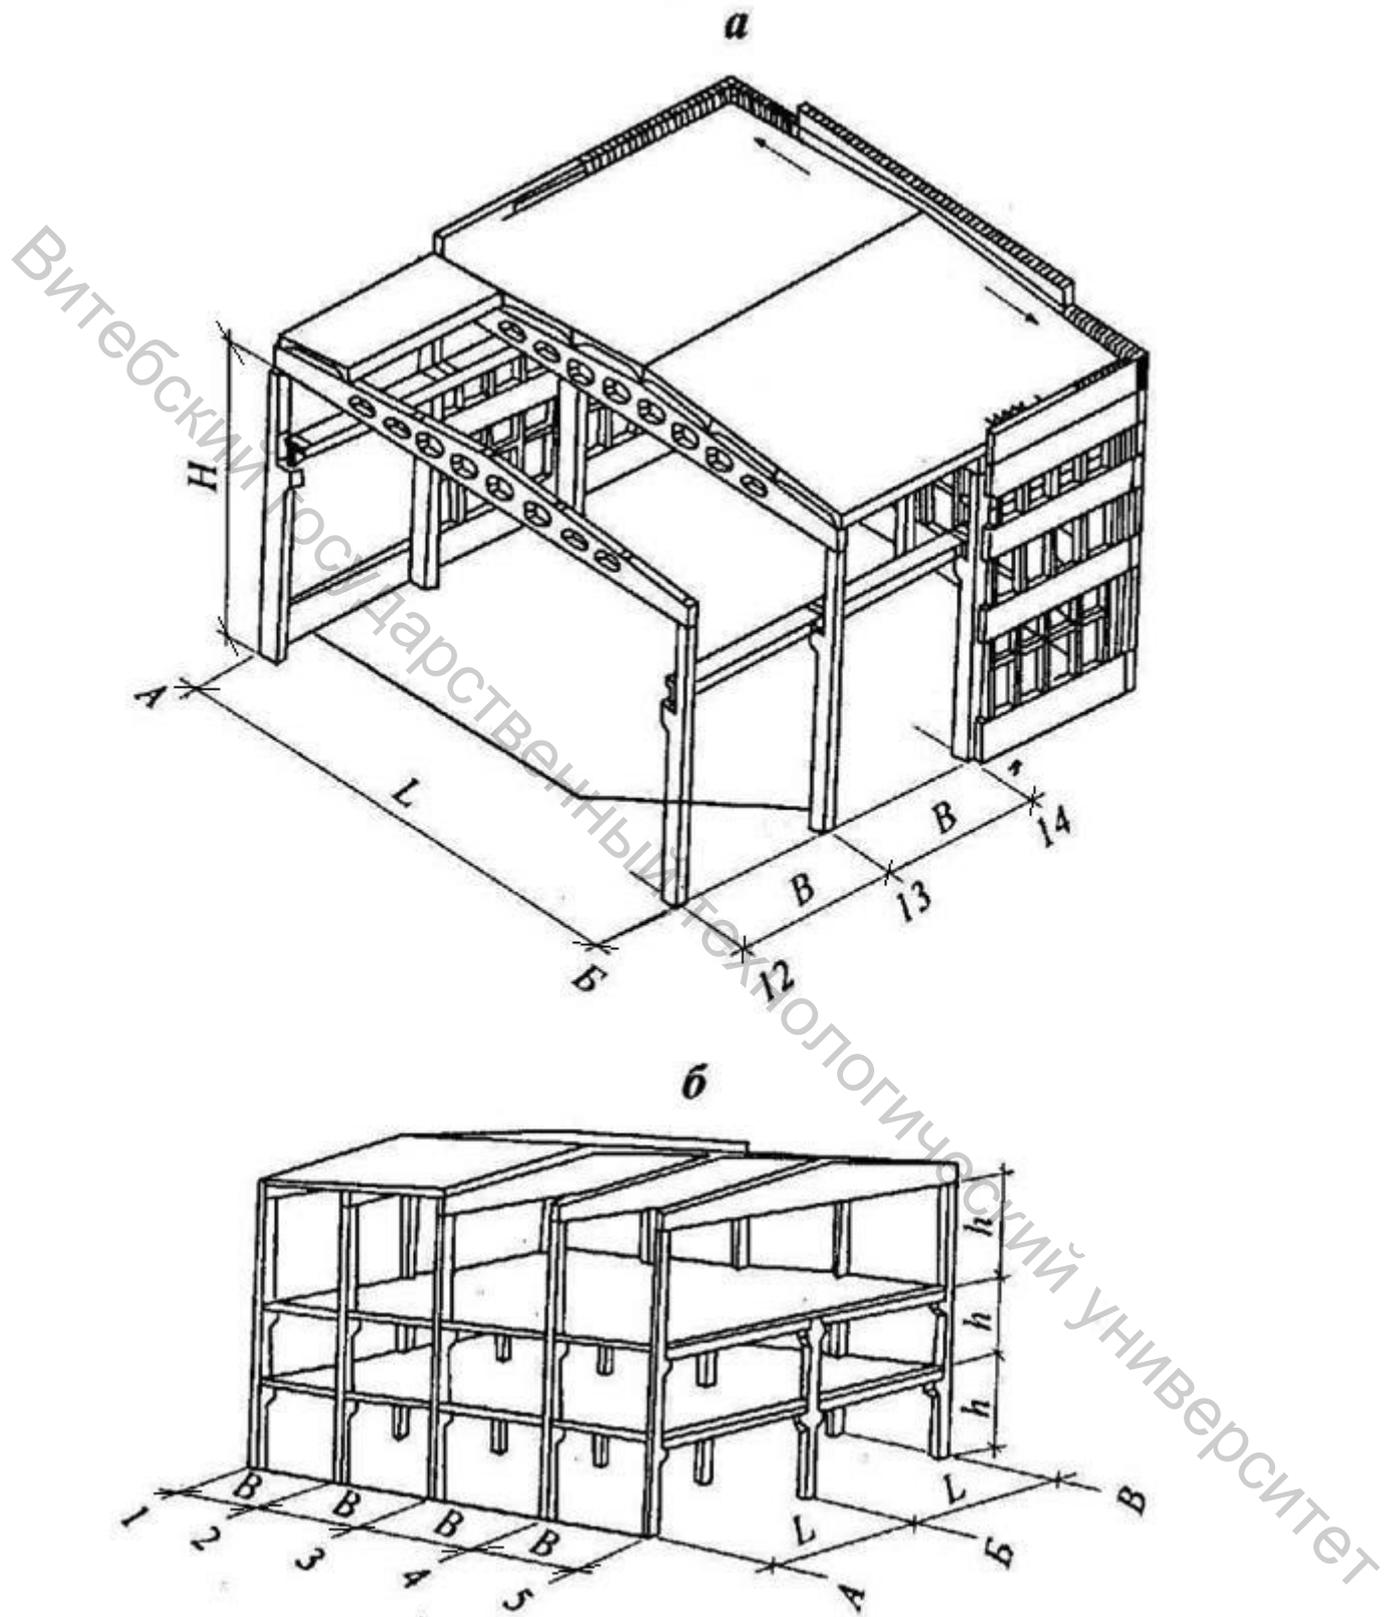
Основные параметры объёмно-планировочного решения промышленных зданий (а – одноэтажных, б – многоэтажных): L – пролёт, B – шаг, H – высота одноэтажного здания, h – высота этажа
